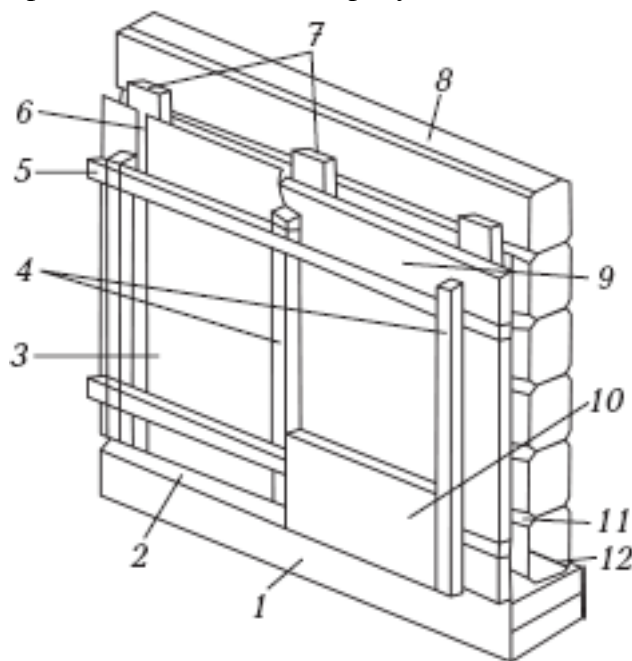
Укладка паро- и теплоизоляции: 1 – стена фундамента; 2 – гидроизоляция; 3 – пароизоляция; 4 – вертикальные планки каркаса для второго слоя утеплителя; 5 – горизонтальные планки каркаса для первого слоя утеплителя; 6 – самоклеящаяся лента, герметизирующая крепежные отверстия в пароизоляции; 7 – каркас из досок; 8 – бревенчатая стена; 9 – первый слой теплоизоляции; 10 – второй слой теплоизоляции; 11 – вентиляционный зазор; 12 – вентиляционное отверстие
